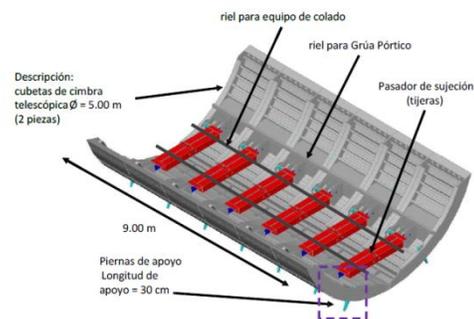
Sección inferior de un módulo de la cimbra telescópica.
